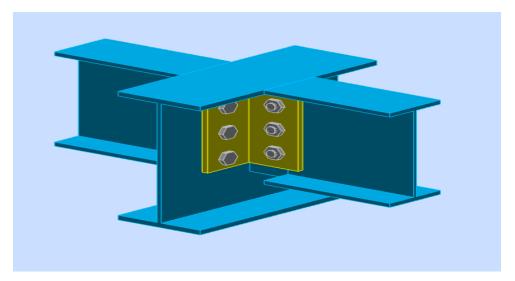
Vue en 3D de l'assemblage solive-poutre mixte
